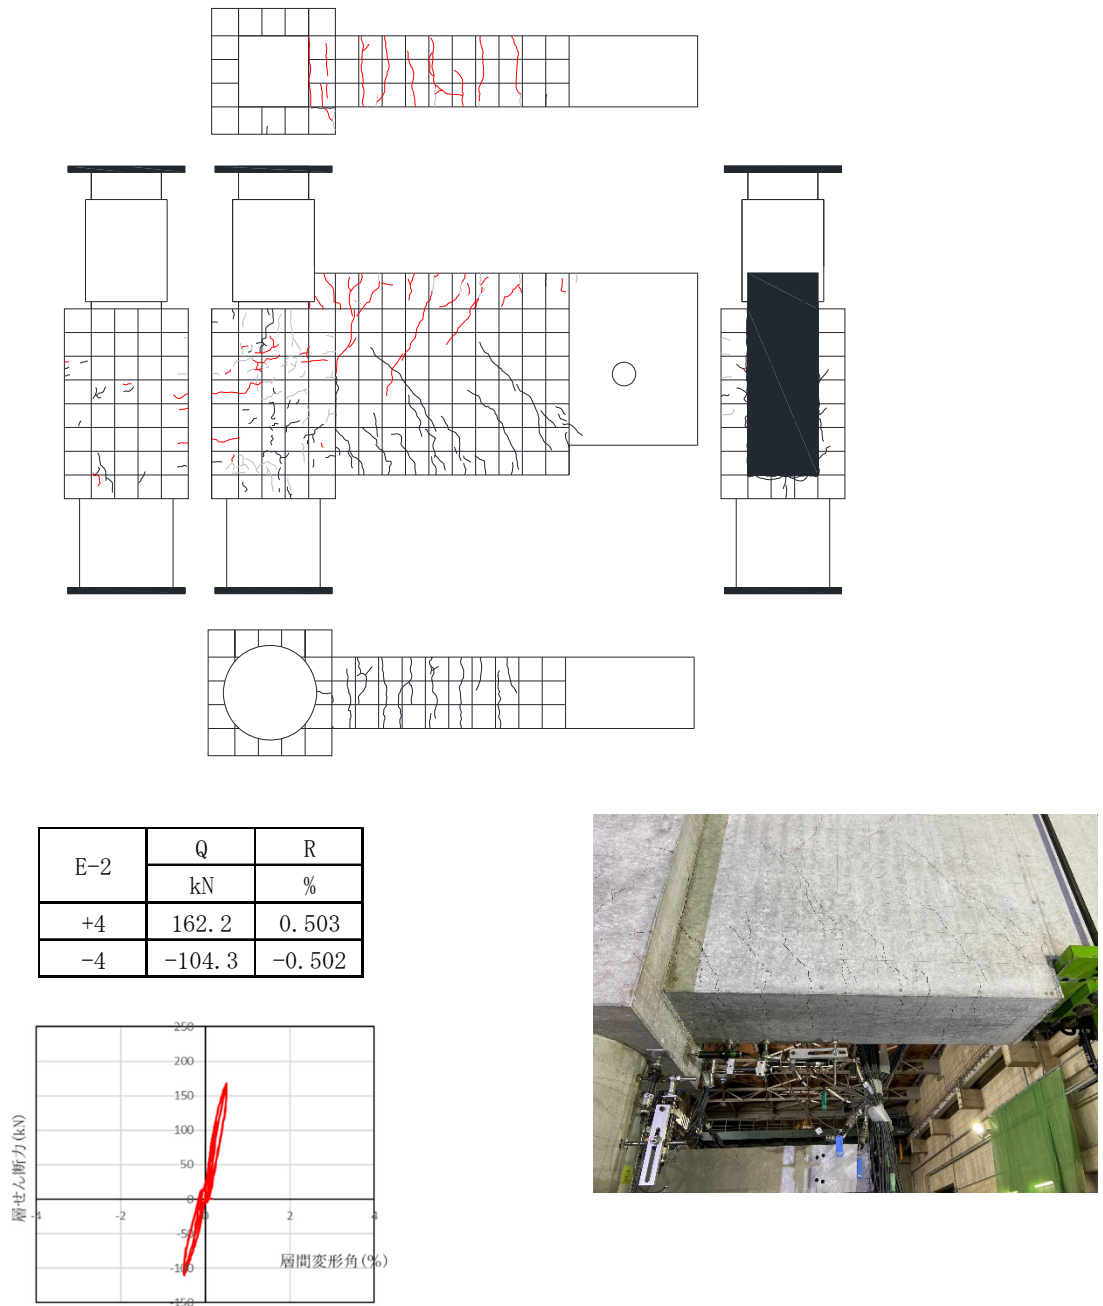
3. 2-11 E-2 ひび割れ状況 (1Cycle)
